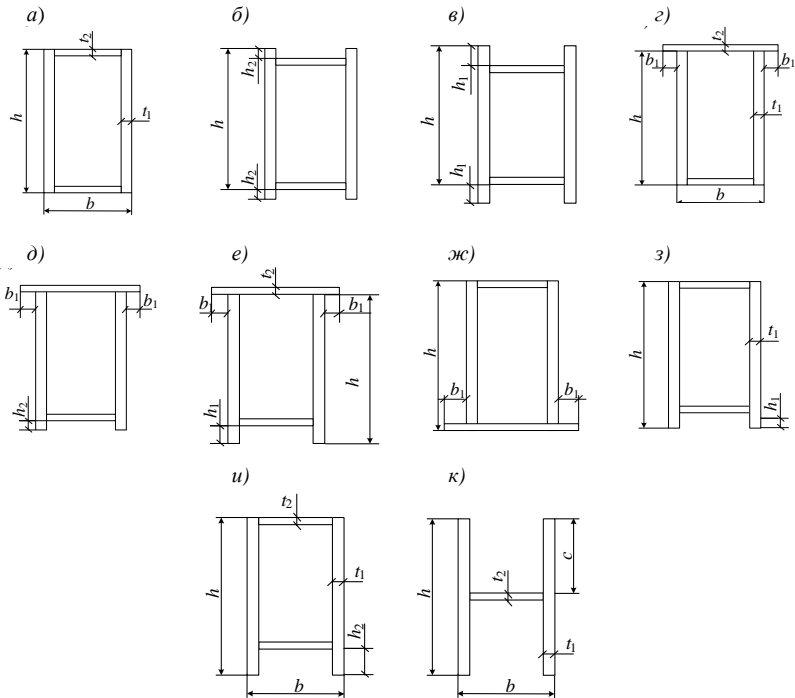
Основные типы сечений сварных элементов главных ферм:
